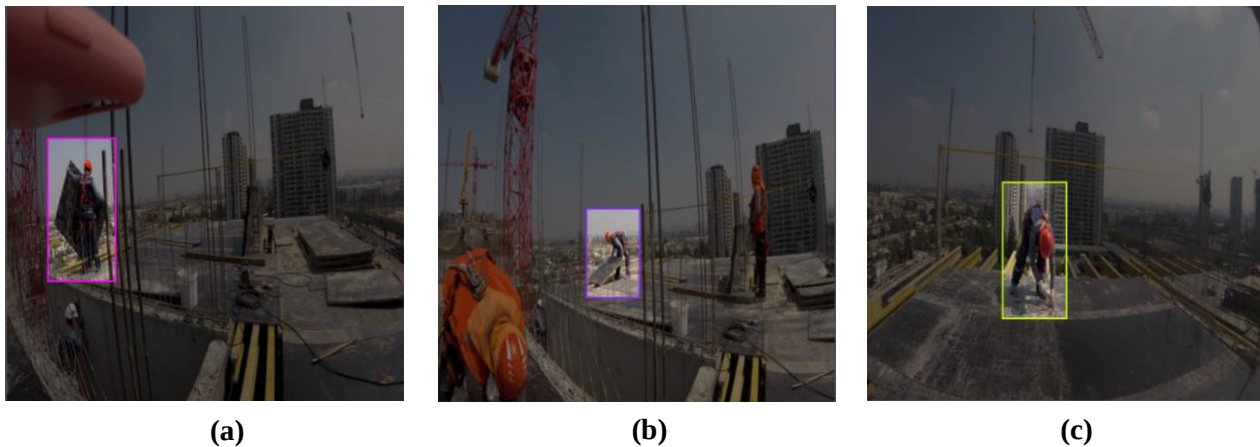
Set de imágenes etiquetadas para tarea de instalación de placas:(a) IP01, (b) IP02, (c) IP03.
